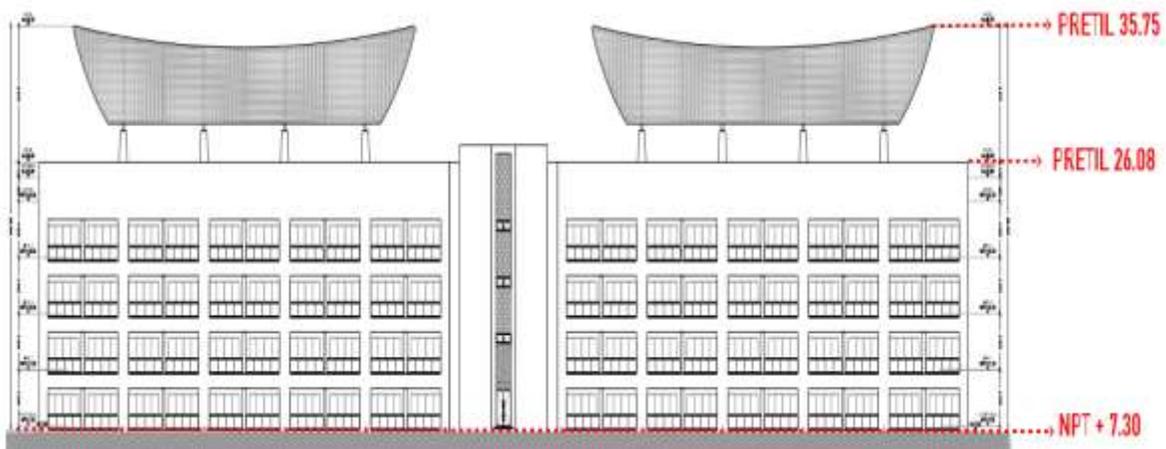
SEGMENTO DEL PLANO ARQUITECTÓNICO- EDIFICIO TIPO B1
